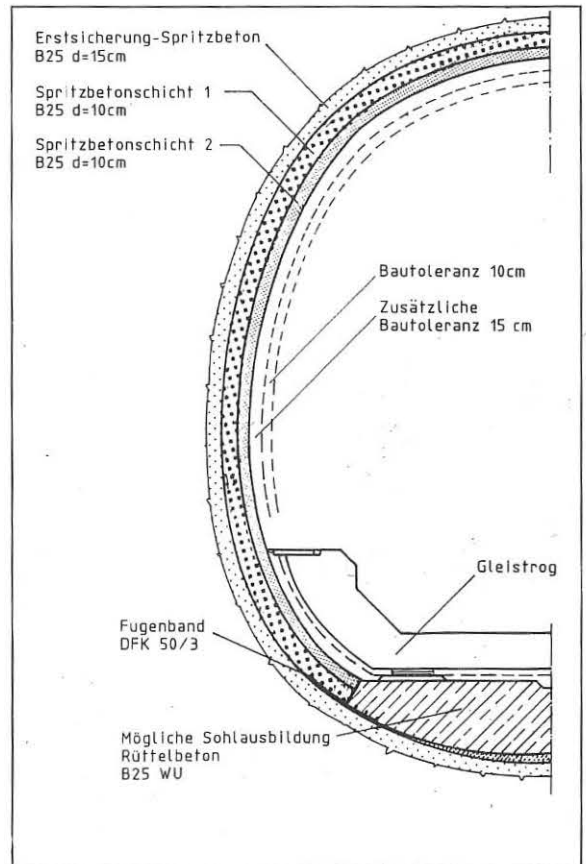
Einschalige Stollen- und Tunnelauskleidung in Spritzbeton
